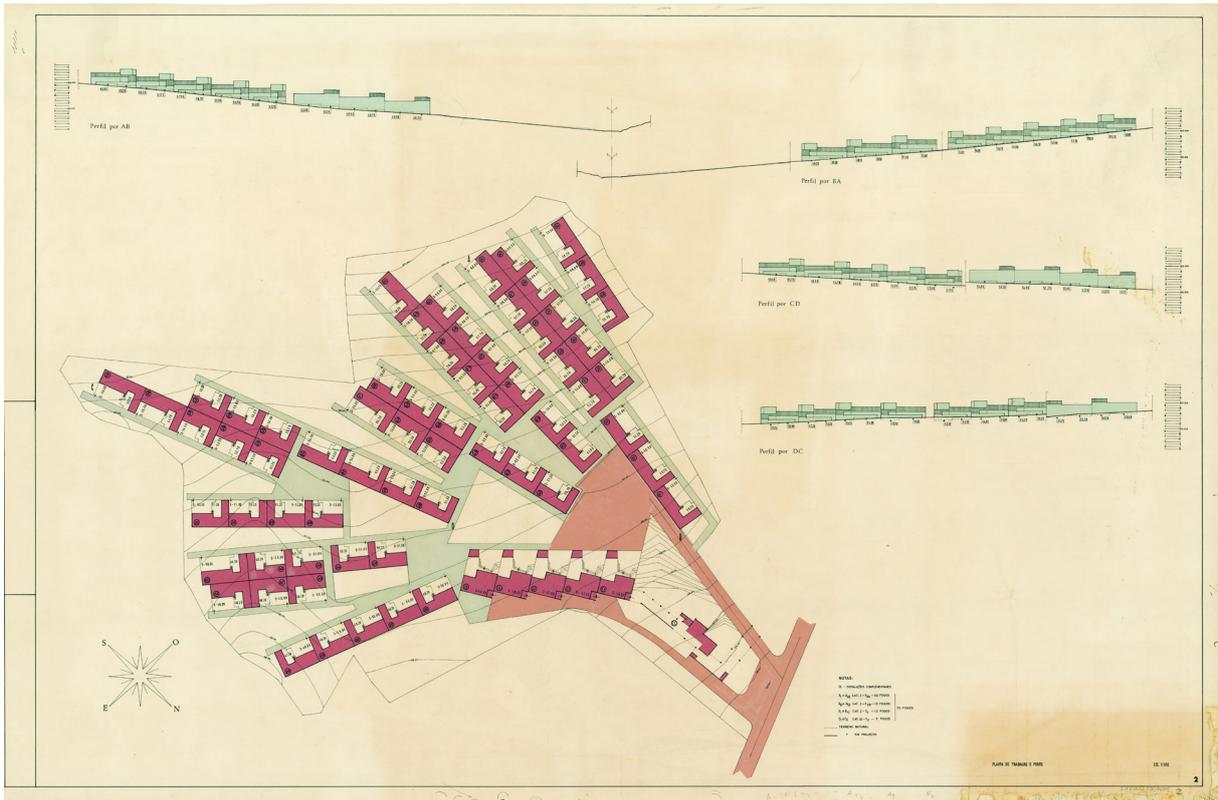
Anteprojeto: planta de trabalho e perfis
